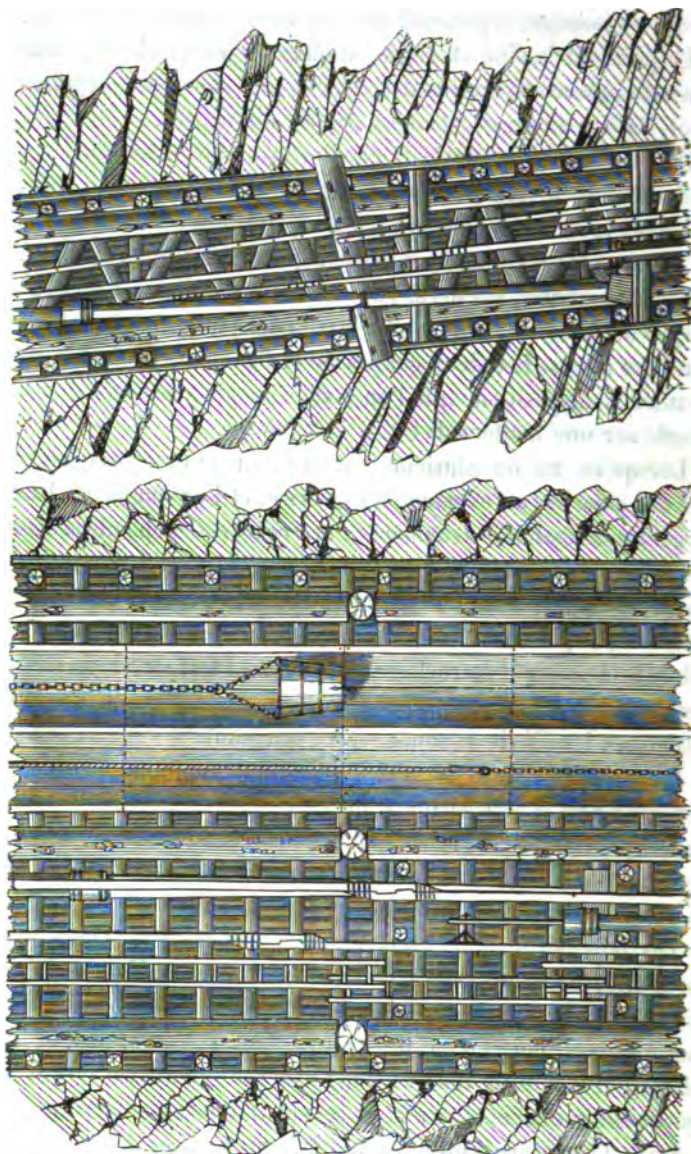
Coupe d'un puits rectangulaire boisé, au Harz.
